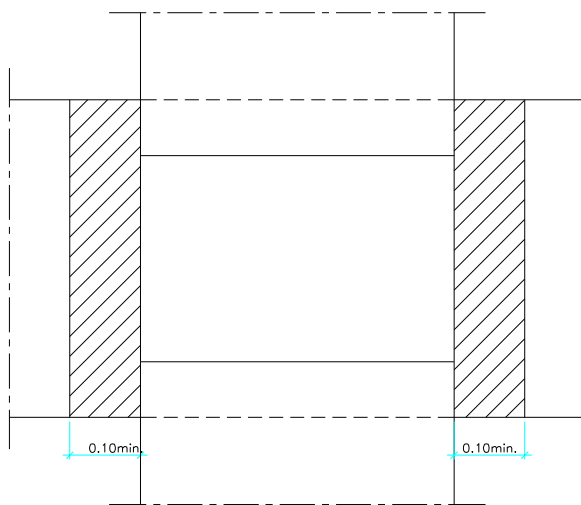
Joint plat sur terrasse accessible aux piétons, raccordement sur un revêtement asphalte
